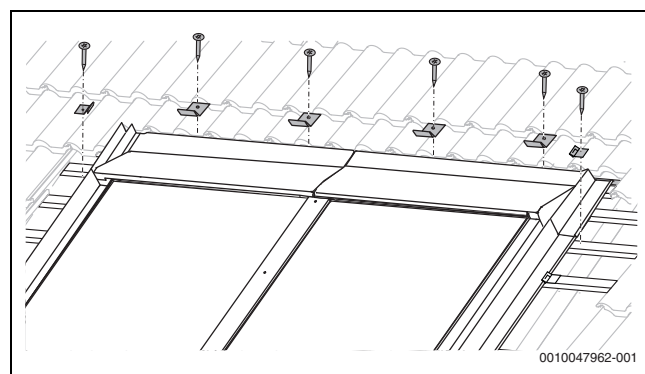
Obere Eindeckbleche mit Haftern fixieren
